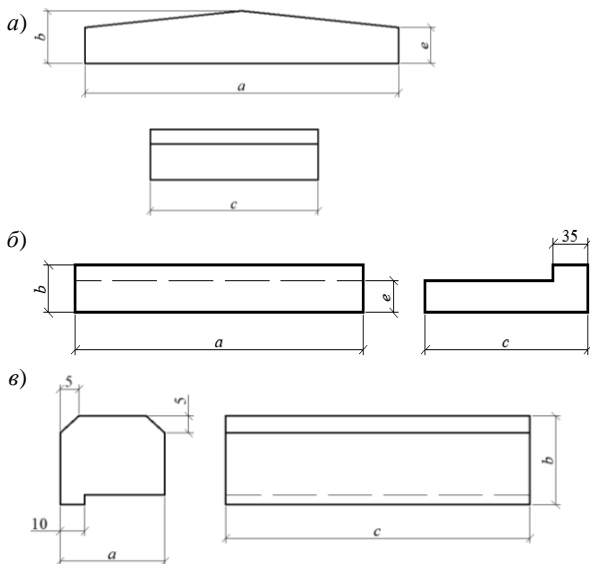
Элементы перекрытия бетонных водопропускных труб:
